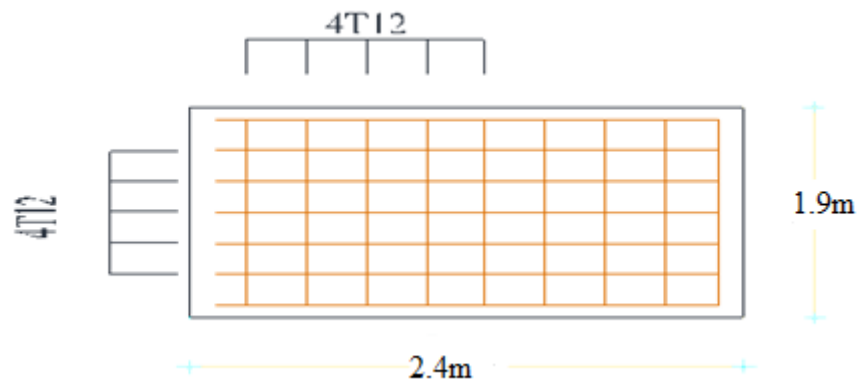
Schéma de ferrailage da la dalle de machine.
